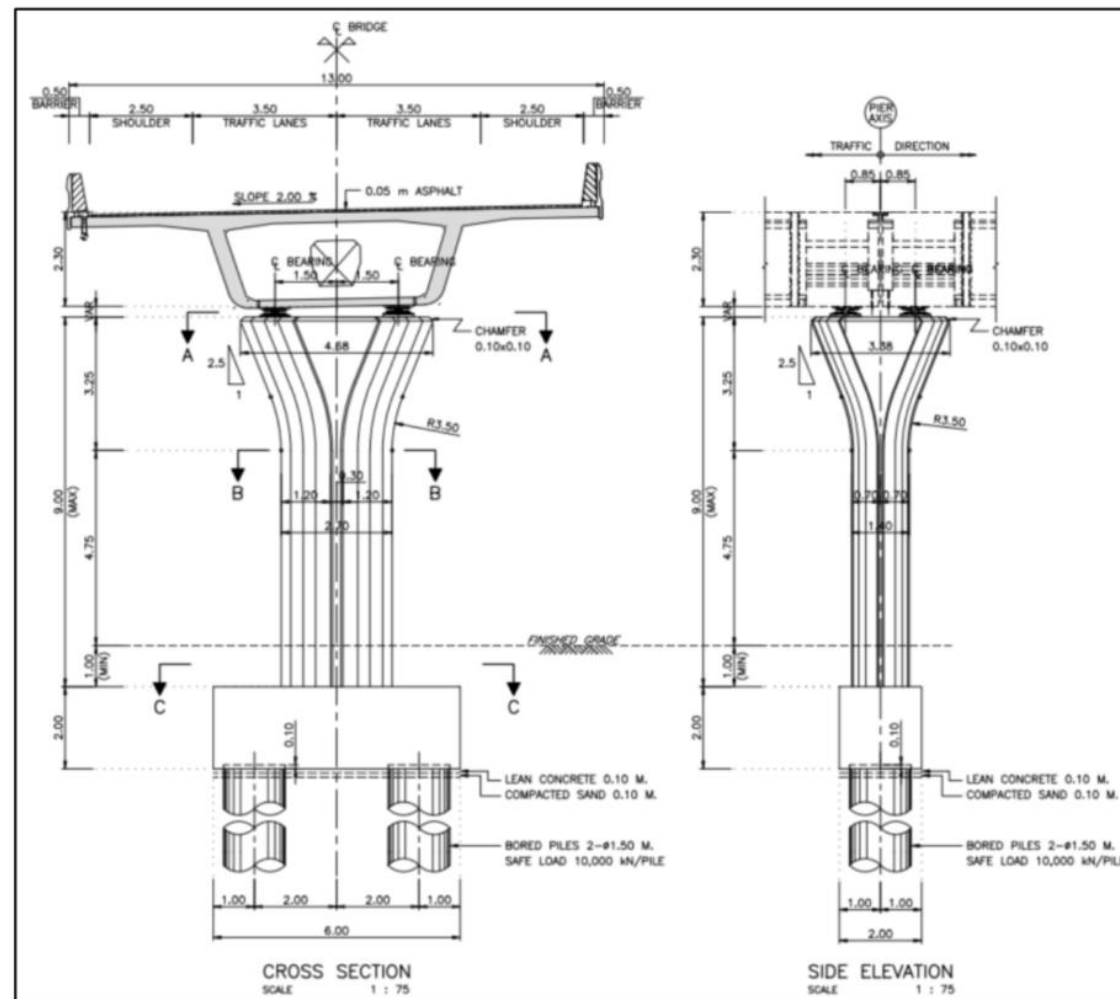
ตัวอย่าง Superstructure สะพานคอนกรีตอัดแรงรูปกล่องใช้ชิ้นส่วนหล่อสำเร็จ (Pre-cast Segmental Concrete Box Girder) รูปแบบความกว้าง Box 13.0 เมตร
